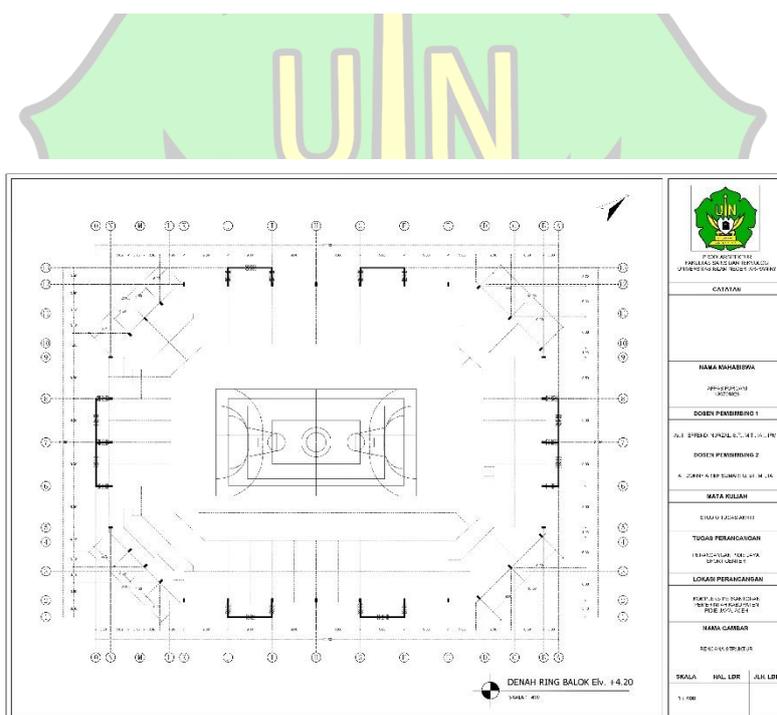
49 Denah Ring Balok Elevasi ±4.00
